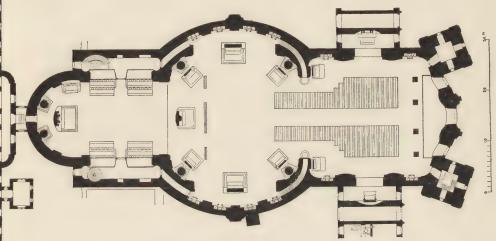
Klofterkirche zu Wiblingen. Grundriss.
